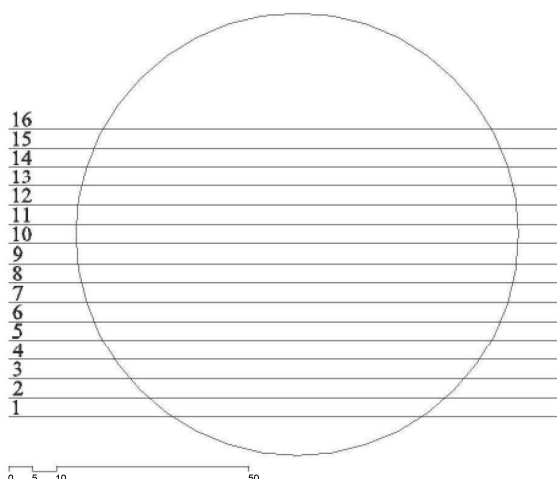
Alzado de los niveles que van a servir como graderío. Elaboración propia.
